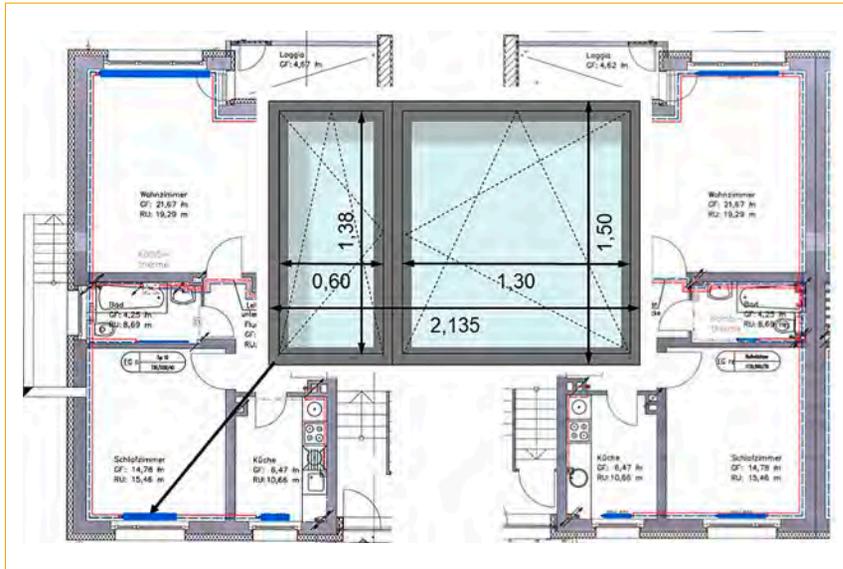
Grundriss mit fensterlosem Badezimmer (rechter Ausschnitt) und Badezimmer mit Fenster [Quelle: Studie zum Lüften im Wohnungsbau]
